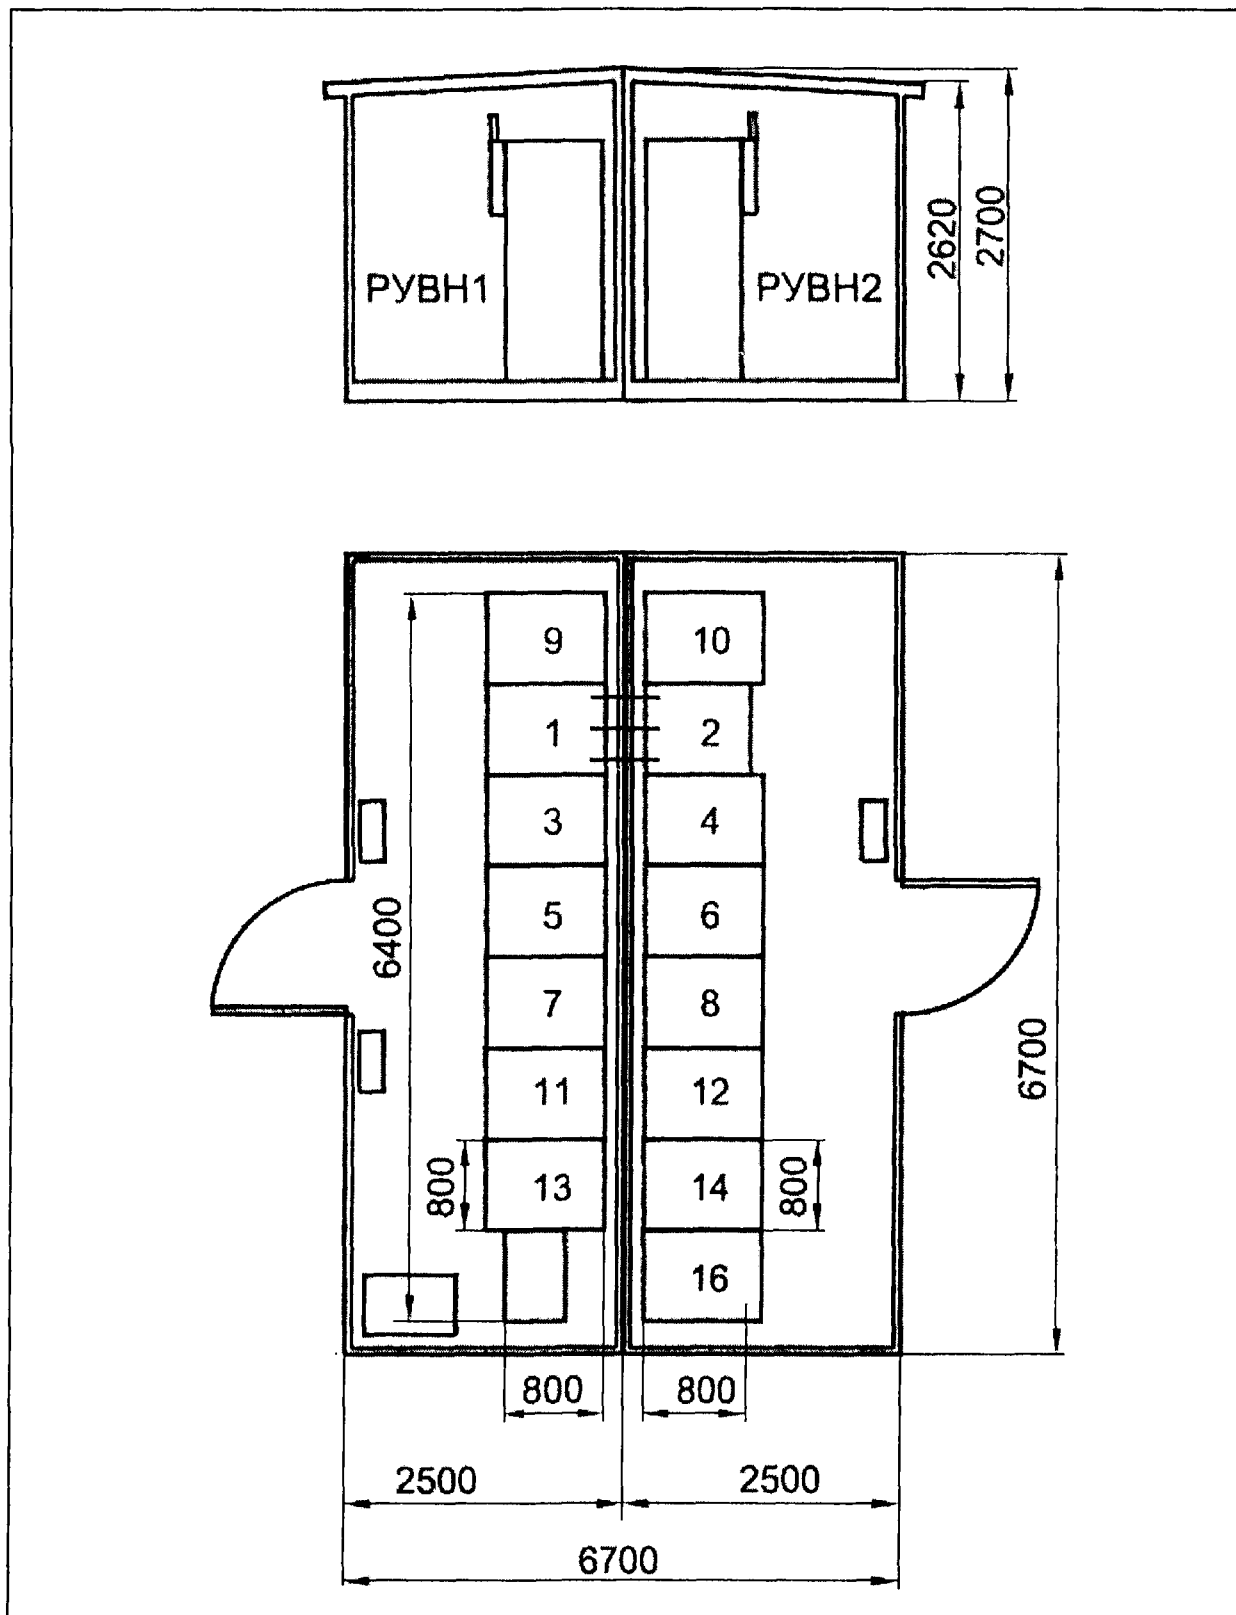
Общий вид, компоновка и габаритные размеры РУ-10-УХЛ1
